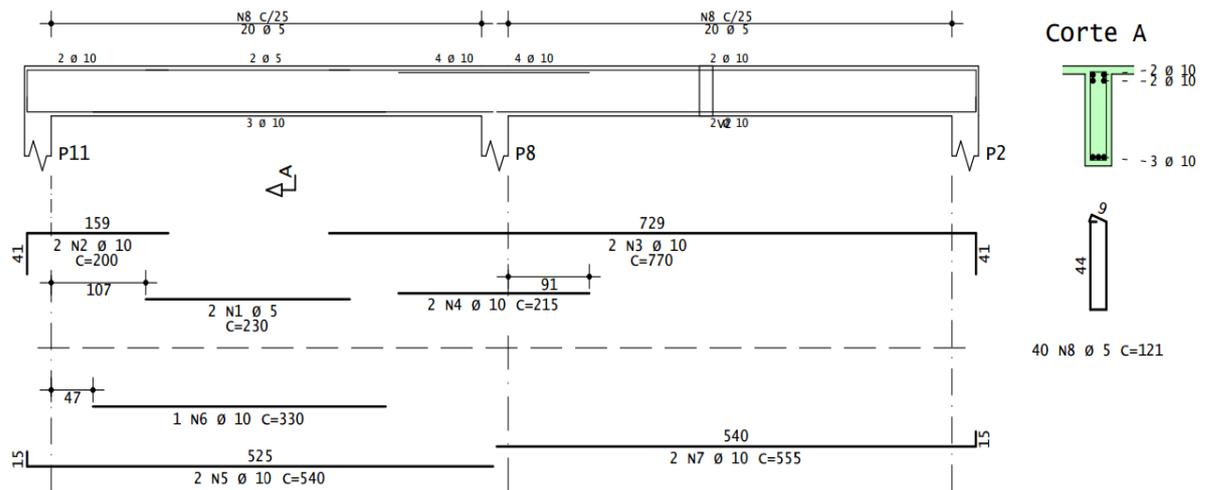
Armadura da viga V8 – coberta (nível +6,00)
